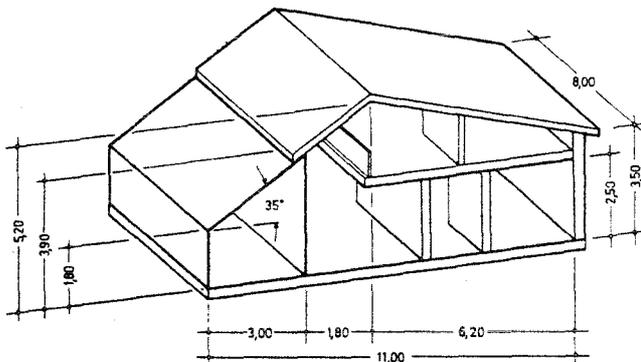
/1: Schematische Darstellung des untersuchten Einfamilienhauses mit Vermaßung. In der seitlichen und in der rückwärtigen (dem Wintergarten abgewandten) Fassade befinden sich Fenster mit einem Fensterflächenanteil, bezogen auf die Hausfassadenfläche ohne Wintergarten, von jeweils 5%.
